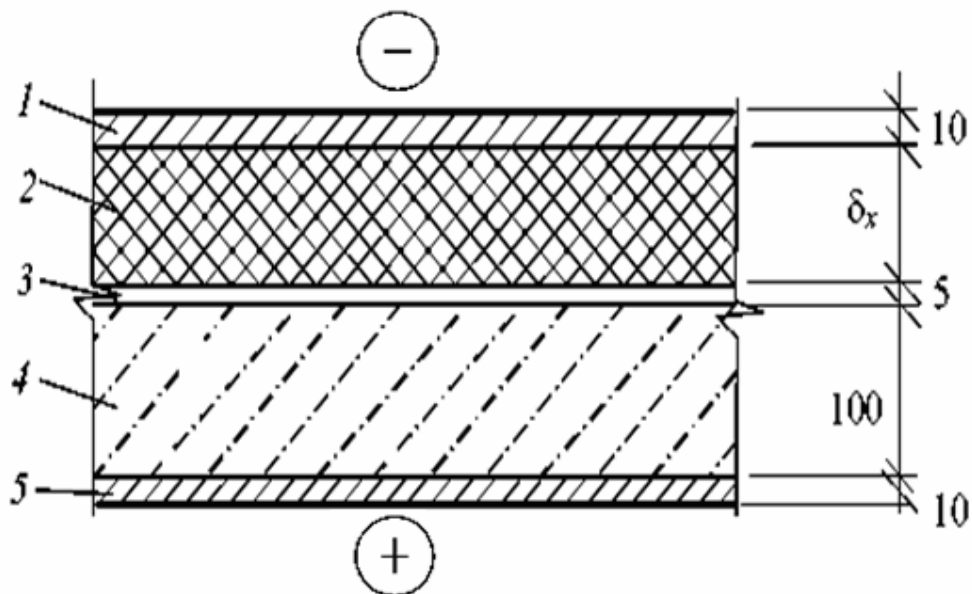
Вариант 2-й конструкции чердачного перекрытия:
